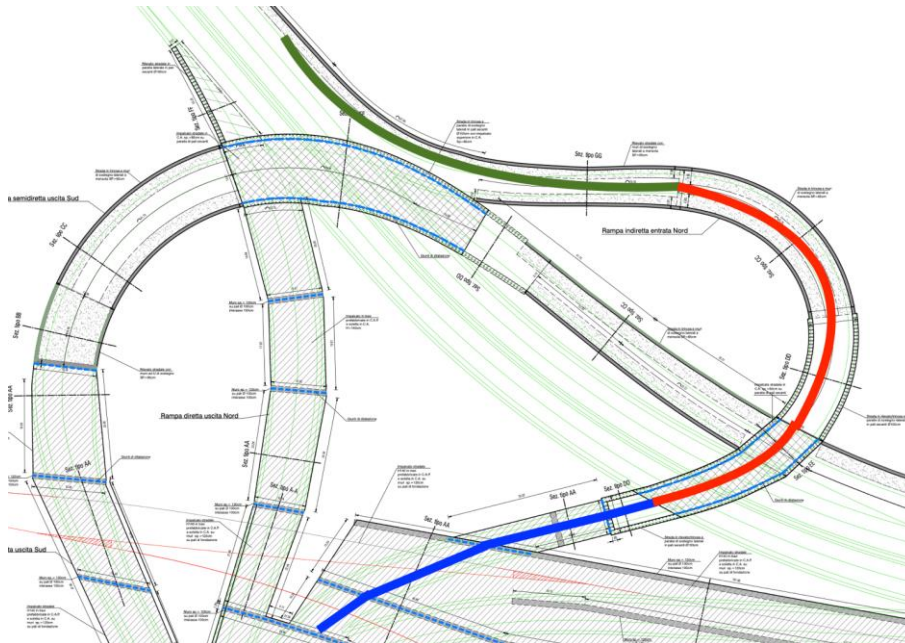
Planimetria con evidenziata la rampa indiretta in entrata Nord: in blu i tratti di rampa su impalcato, in rosso la parte in trincea e in verde i tratti di rampa in rilevato
